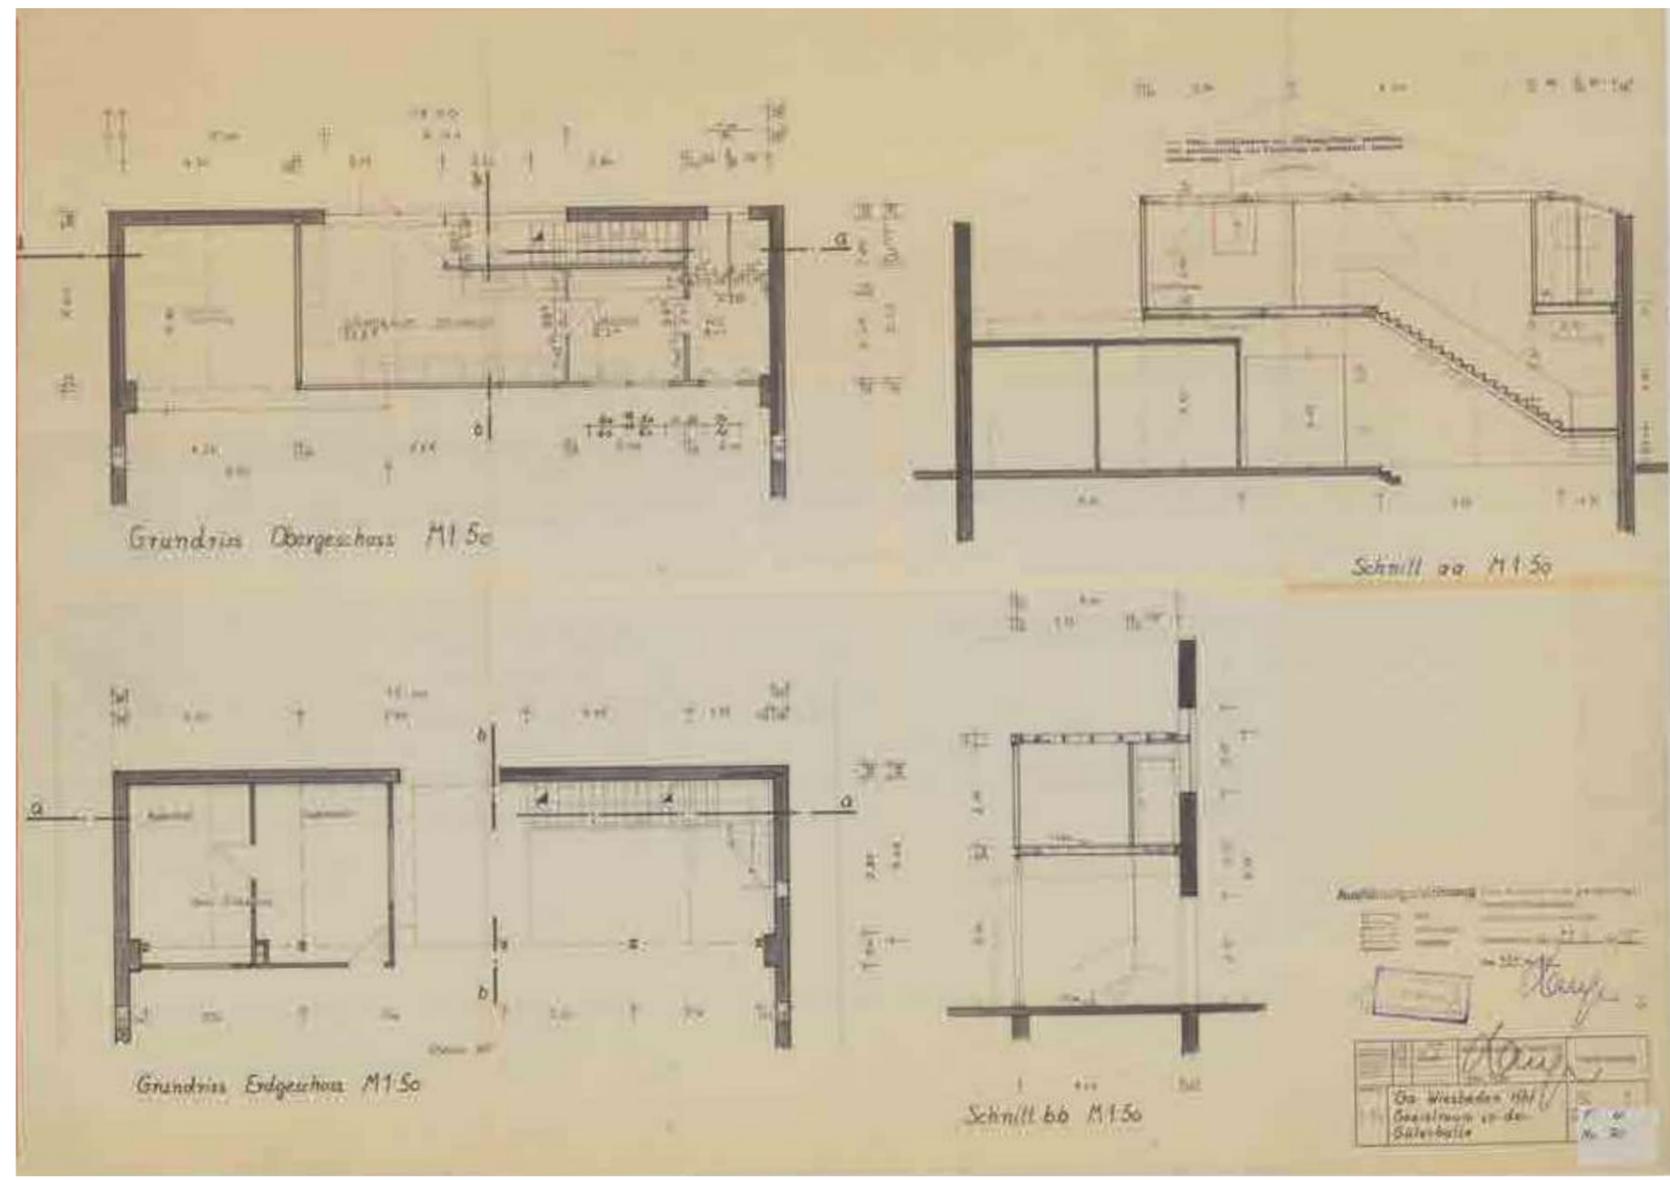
Stückgutschuppen: Plan zur Errichtung von Sozialräumen im Erdgeschoss am Südende der Güterhalle, 1975
